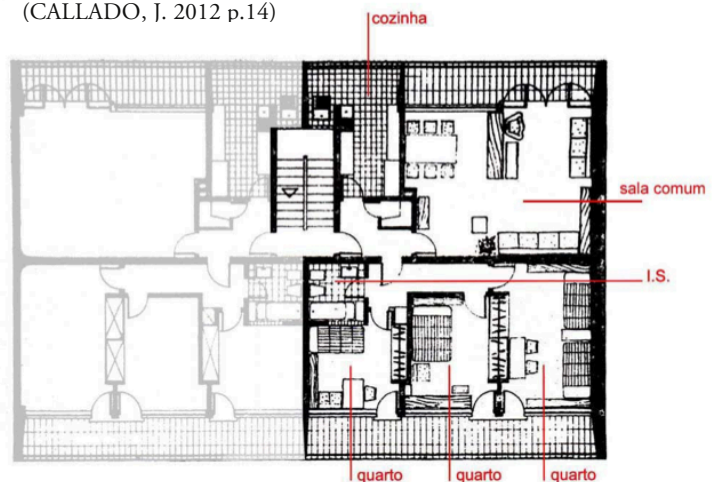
Bairro das estacas - Planta de piso habitacional (PEREIRA, 2010 P. 122)
